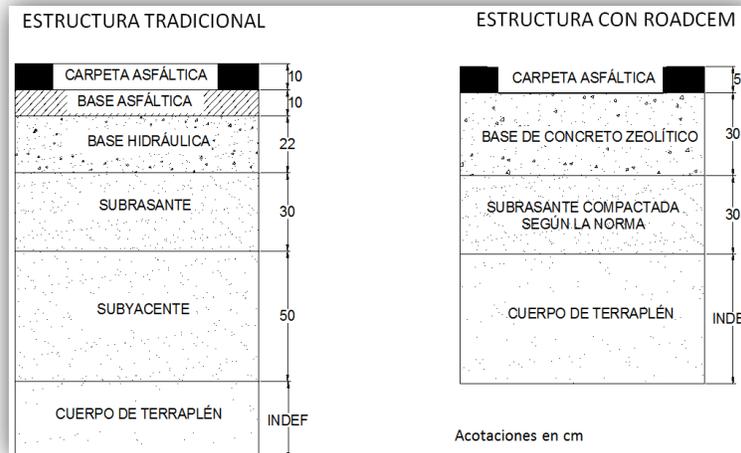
Al construir un pavimento con las capas tradicionales se requiere mayor volumen de material traído de banco, lo cual no sucede al emplear los suelos expansivos existentes en el sitio y tratarlos con RoadCem (formando la Base de Concreto Zeolítico).
